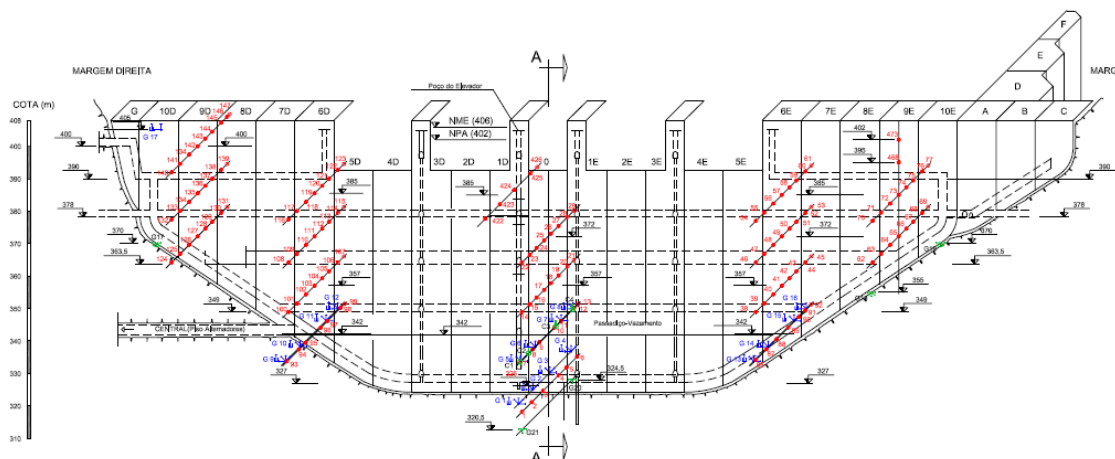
Alçado com localização dos pares termoeletricos, extensômetros e tensômetros da barragem da Bemposta (adaptado de LNEC, 2020).
